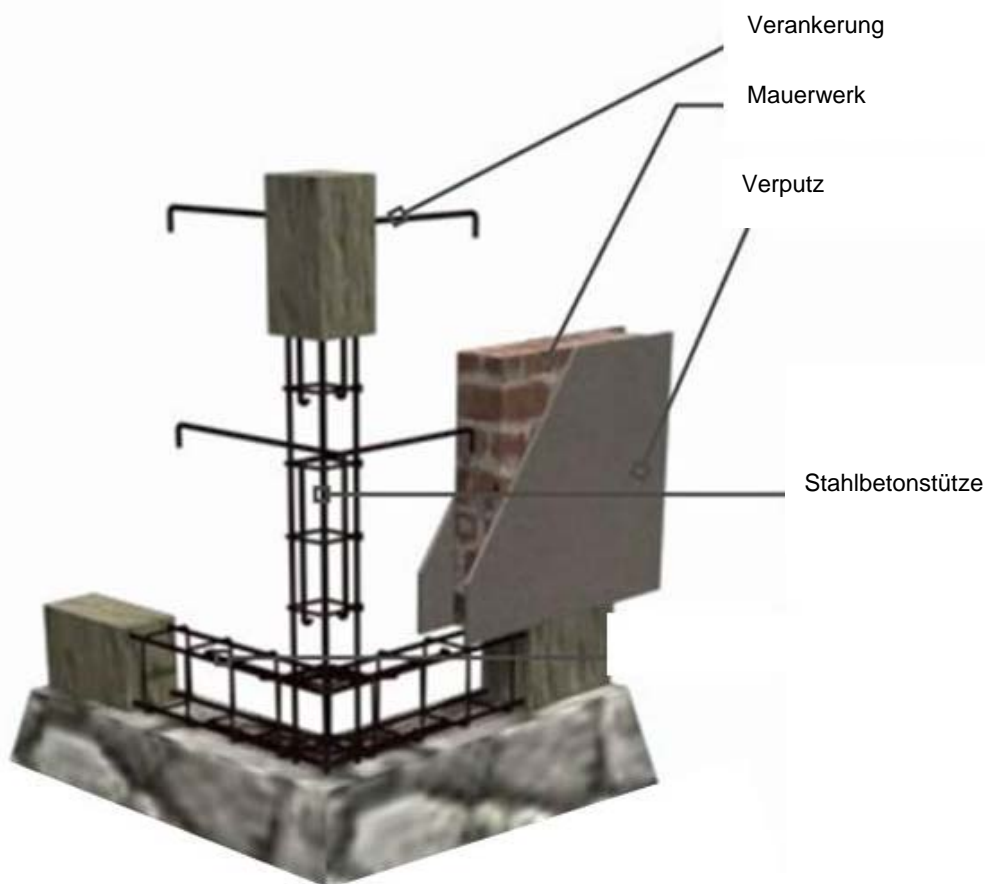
Anschluss Mauerwerk an Stahlbetonstütze (Posyanis (2006))
